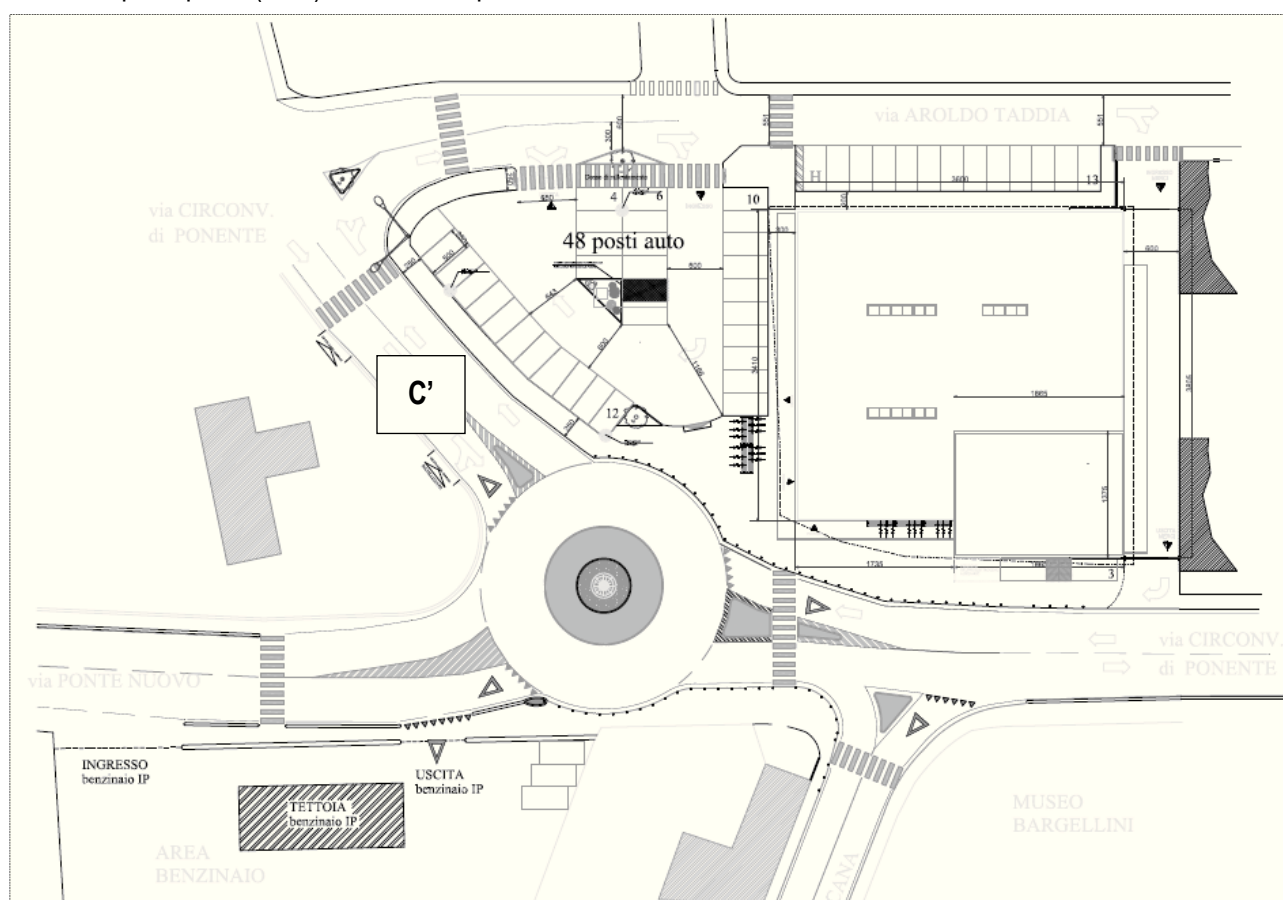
Dettaglio planimetrico dell'accesso all'area di progetto
